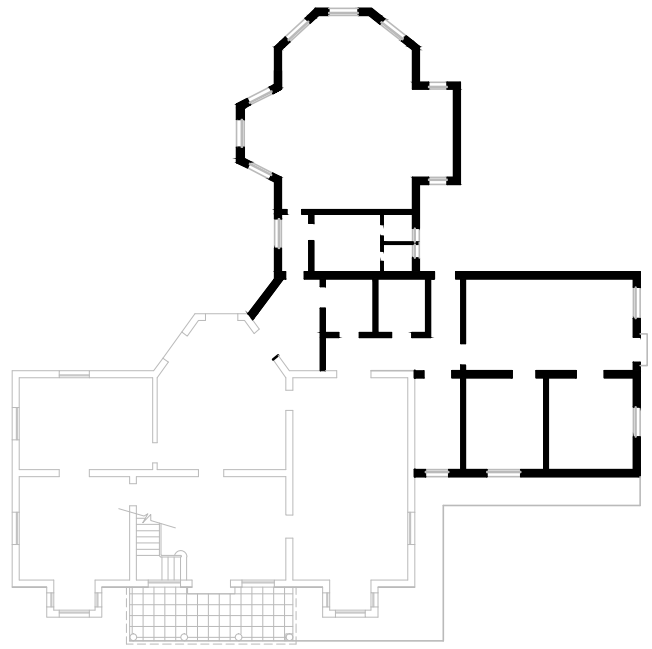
Cricklewood, planta alta y planta baja de la ex casa quinta Kier con la ampliación para funcionamiento del Colegio
